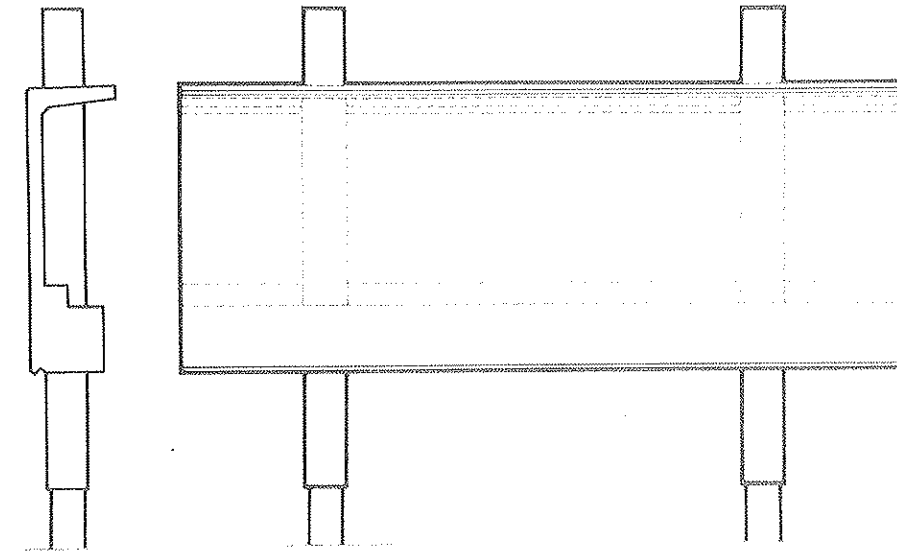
Piezas en H que integran 2 pilares, jácena y elemento de fachada.
